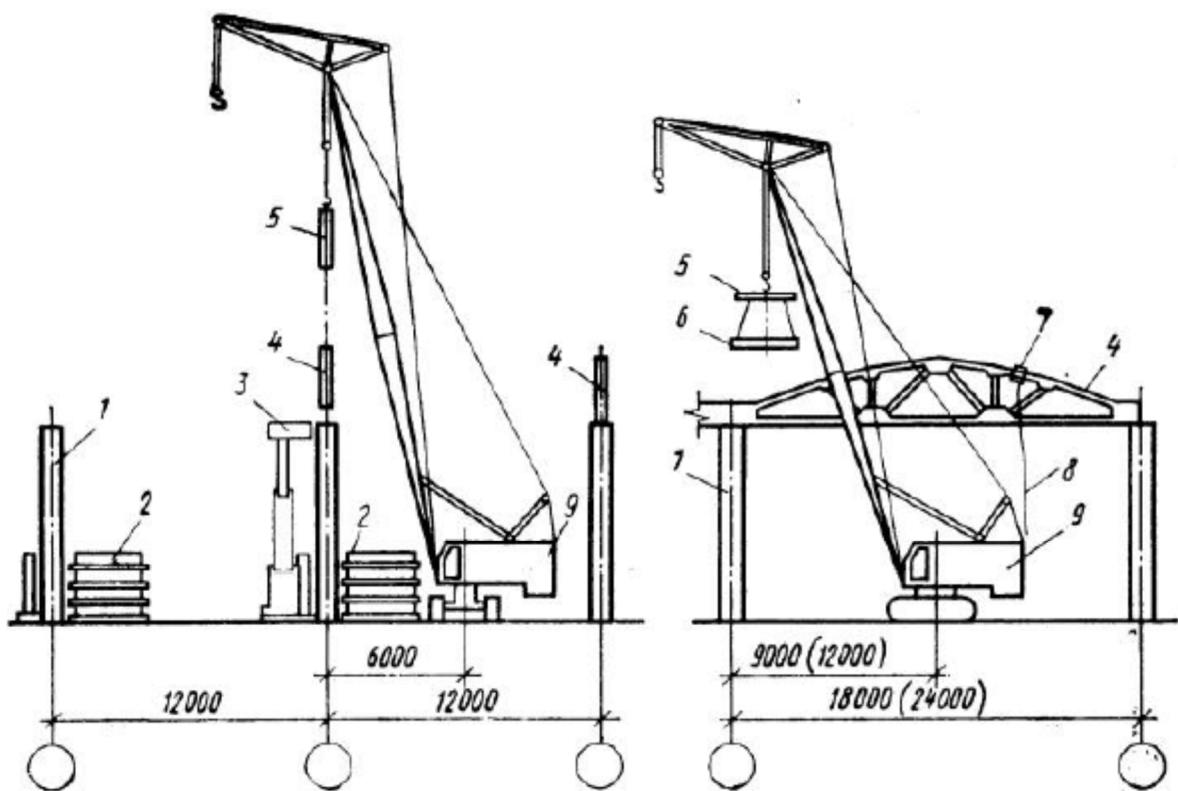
Схемы монтажа фермы пролетом 18 и 24 м и плиты покрытия поперечным методом: 1 - колонна; 2 - штабель плит; 3 - телескопическая вышка; 4 - стропильная ферма; 5 - траверса; 6 - плита покрытия; 7 - инвентарная распорка для временного крепления ферм; 8 - оттяжка из пенькового каната; 9 - кран.
